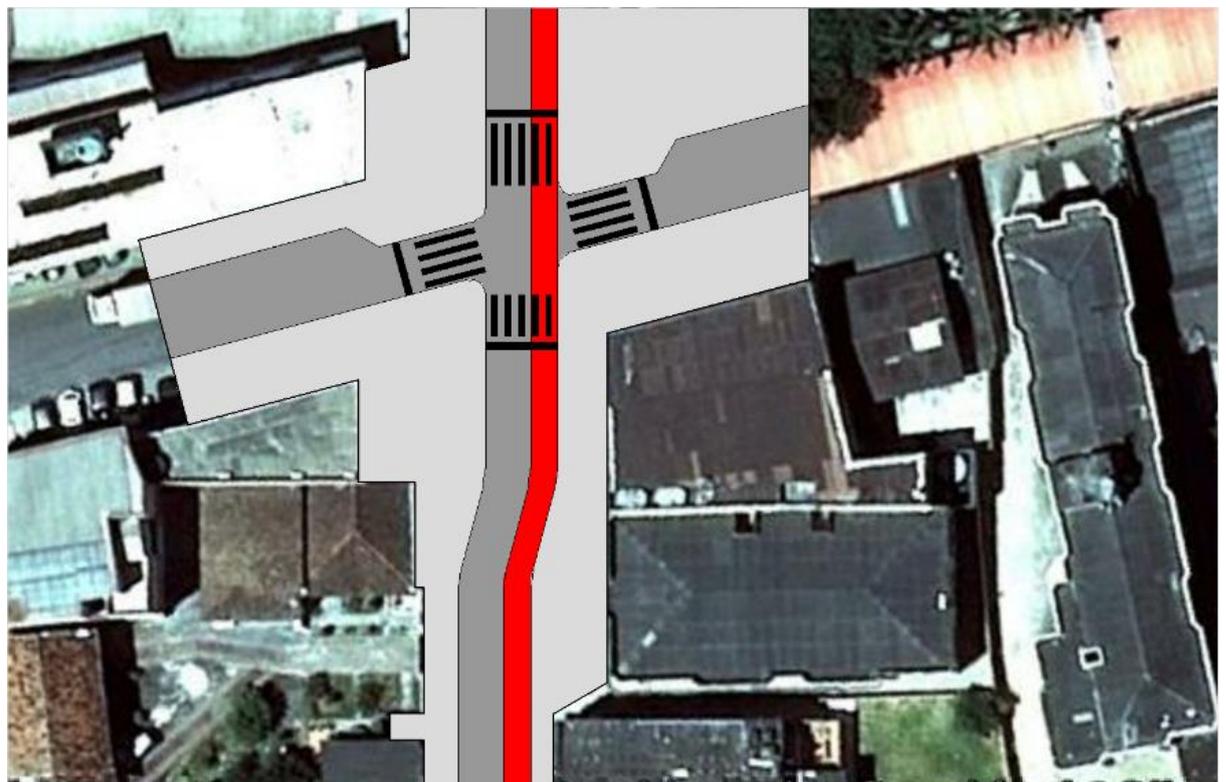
Imagem aérea e planta ilustrada da proposta para a Rua Caetano Silveira de Matos, em Palhoça.
